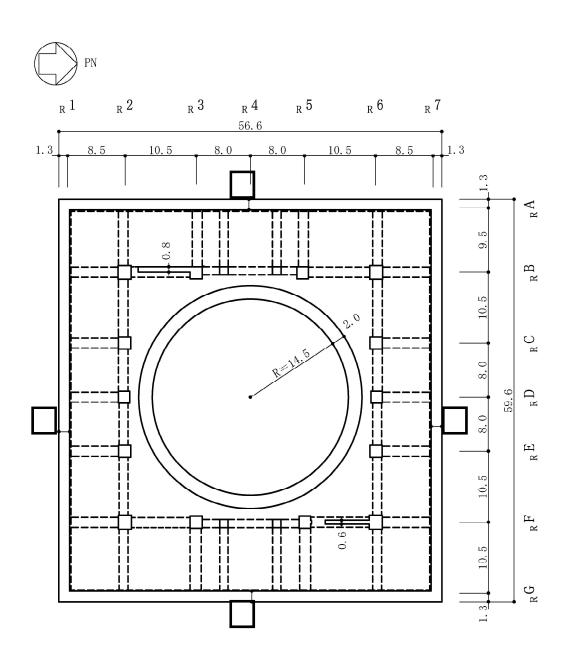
原子炉建屋の概略平面図 (B2F, T.M.S.L.-1.7m) (2/9) (単位:m)
